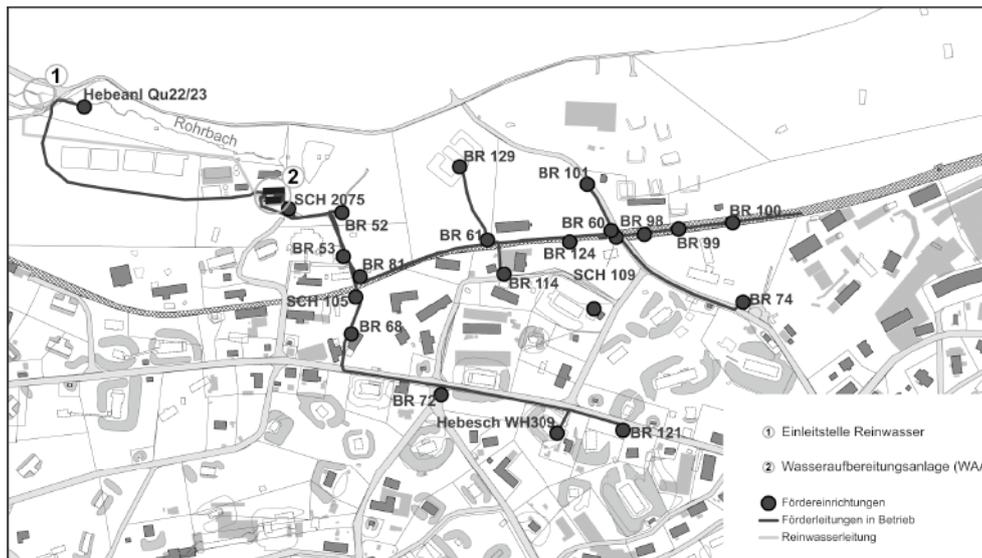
Lageplan der Elemente der hydraulischen Sicherung
